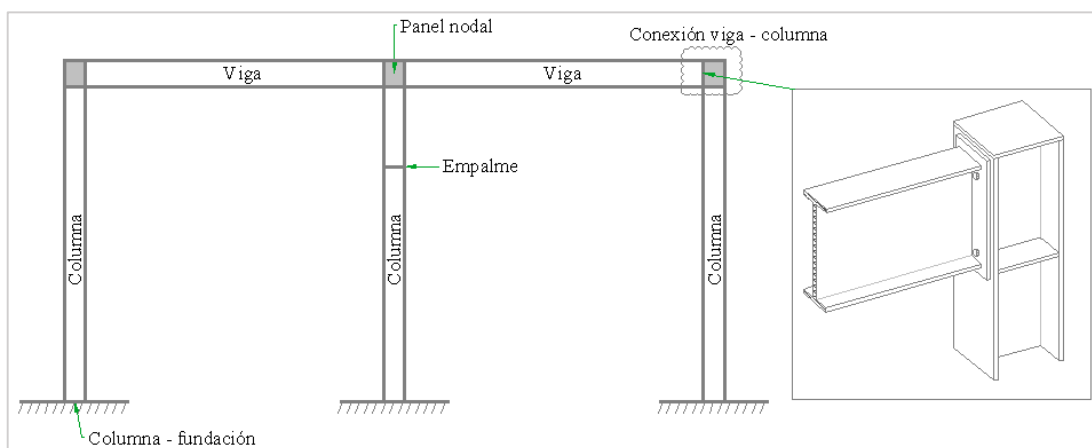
1. Elementos que comprende un sistema estructural tipo pórtico resistente a momento.
